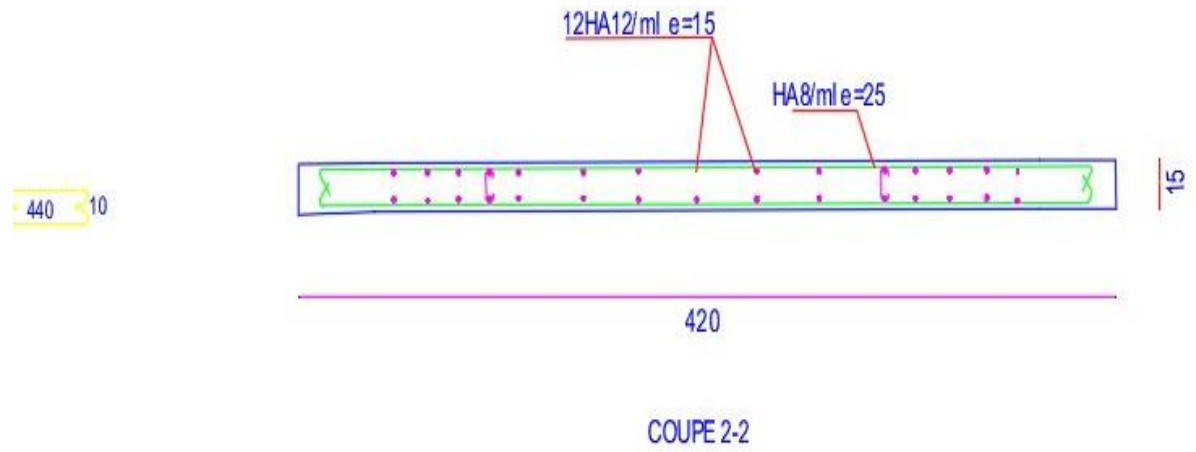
Coupe de ferrailage d'un voile sens y-y (RDC)
